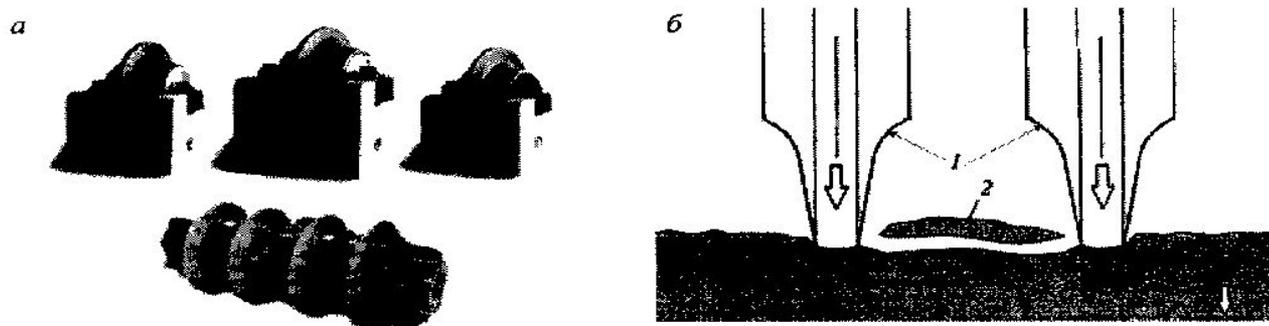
Дисковые шарошки лобового действия (а) и схема отбойки ими породы (б): 1 — дисковые шарошки; 2 — кусок породы, отбитый дисковыми шарошками
